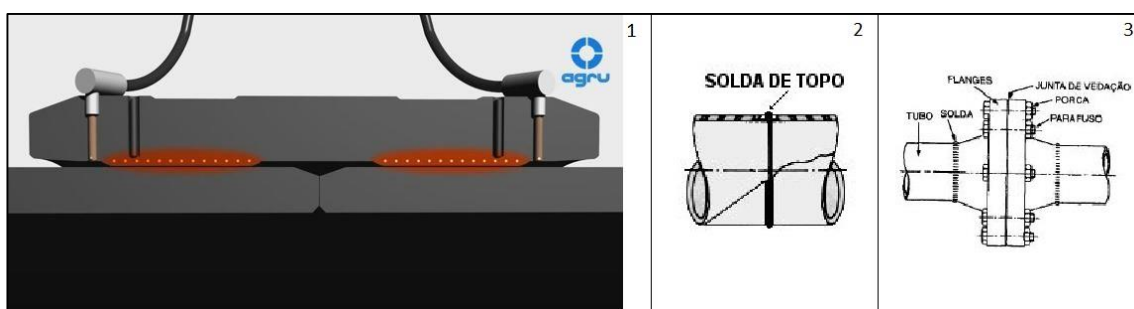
Ligações nos tubos de PEAD: 1) ligação electro soldada; 2) ligação de soldadura topo a topo; 3) ligação flangeada [adaptado de www.agru.at/pt e Ferraz, 2008].
